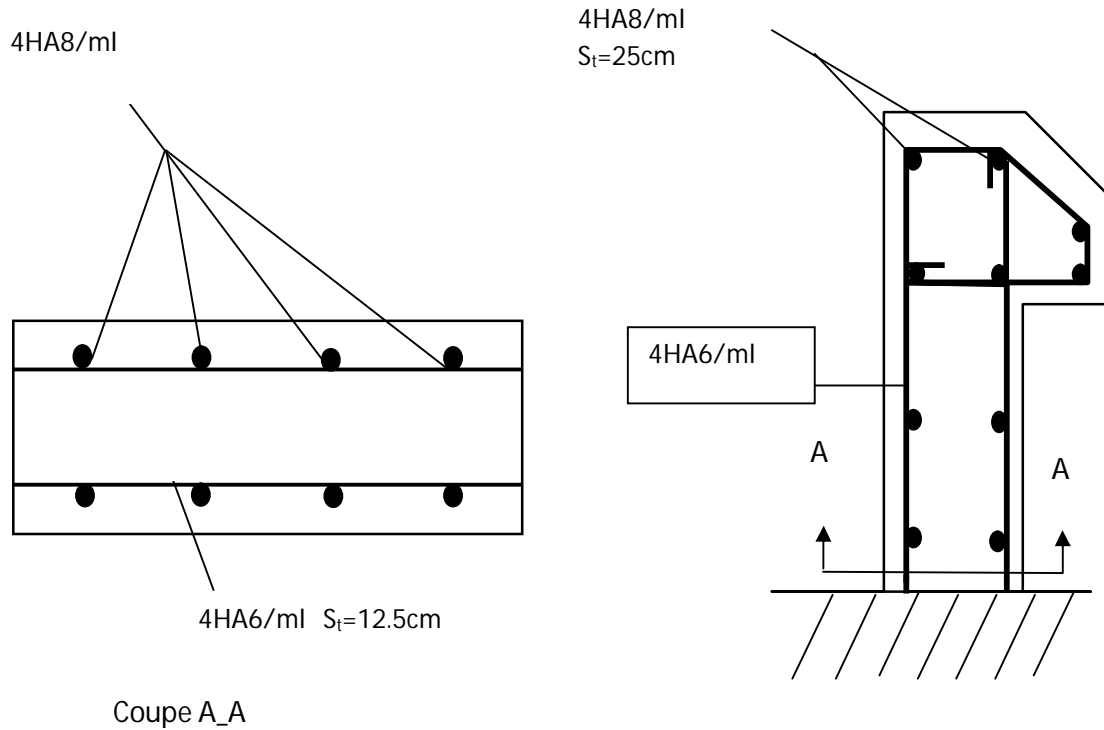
Schéma de ferrailage de l'acrotère 01
